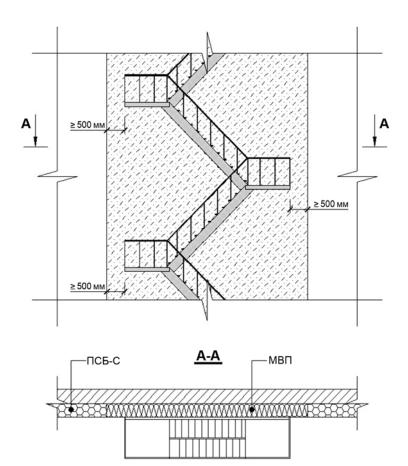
Участки примыкания СФТК к пожарной или наружной маршевой лестнице здания
